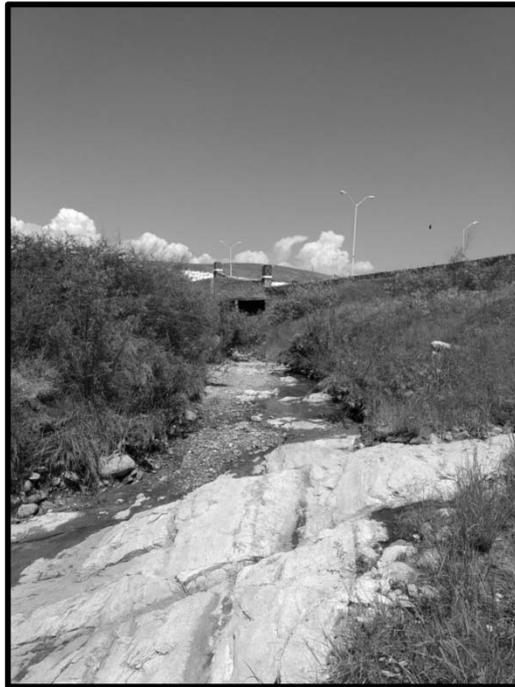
Cauce del arroyo La Palma, paso de la Av. Puente de Piedra. Fuente: Elaboración Propia.
